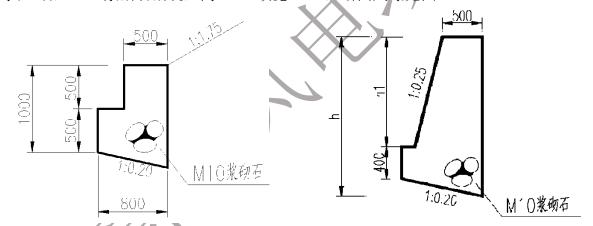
护脚墙断面尺寸图(单位: mm) 图 6.7.4-2 挡土墙断面尺寸图(单位: mm)
